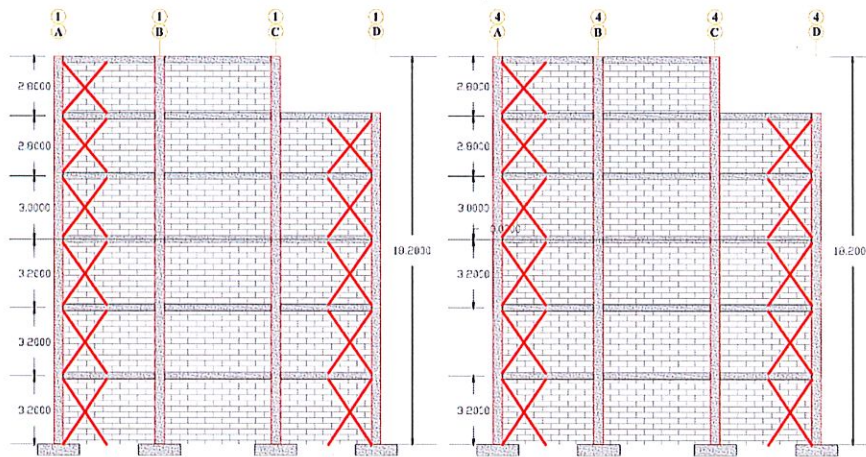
Planos de vista en corte del modelo estructural de hormigón armado con muros estructurales.
